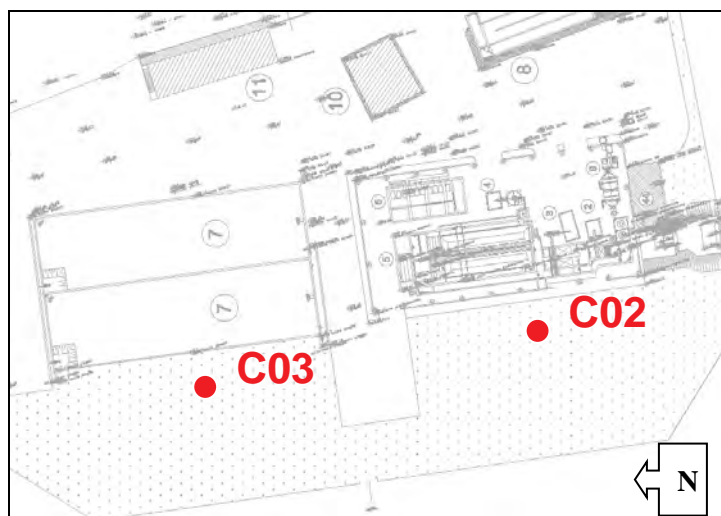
Comune di Pinerolo, area depuratore: ubicazione dei sondaggi per i campionamenti C02 e C03 (su stralcio della planimetria di progetto – non in scala).
